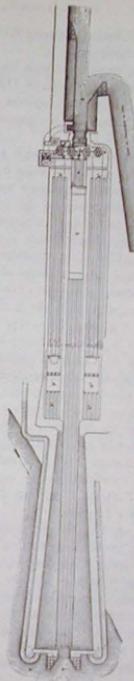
Piano inclinato di Georgetown (Piano generale).
